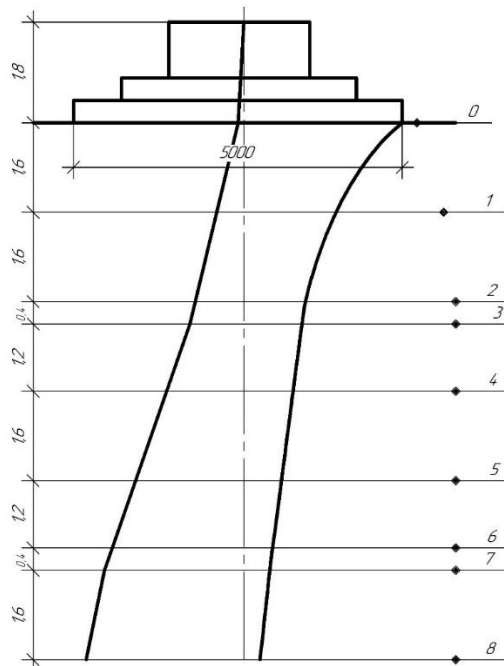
Розрахункова схема і допоміжна таблиця для визначення осідання фундаменту (під крайню колону)
